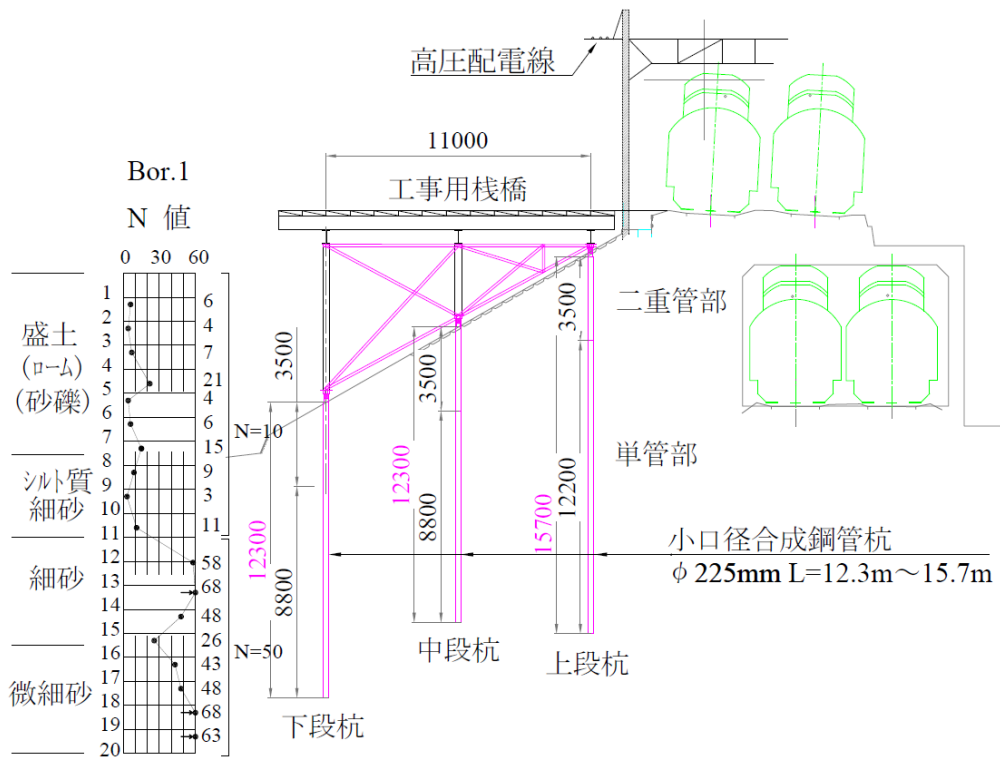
工事用栈橋と基礎杭 (A-A 断面)
